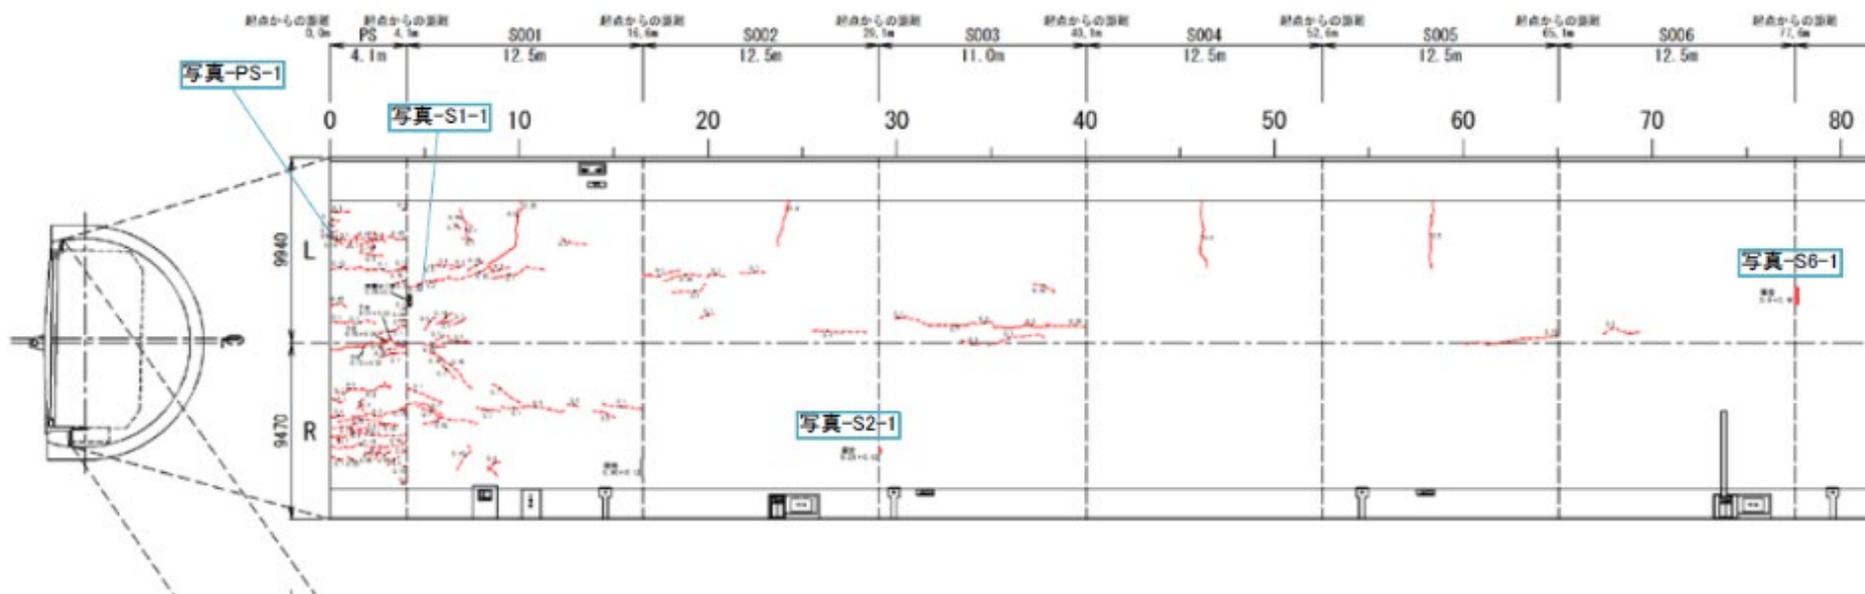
定期点検時の覆工コンクリートのひび割れ図の例
